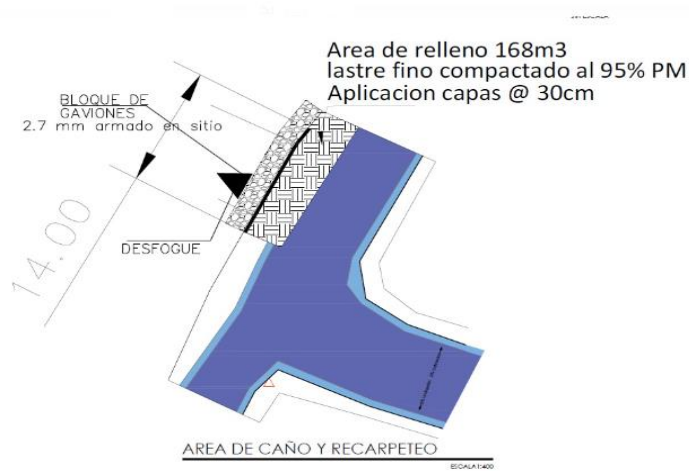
Dimensiones de área recuperada junto a muro de contención en calle Paraíso
